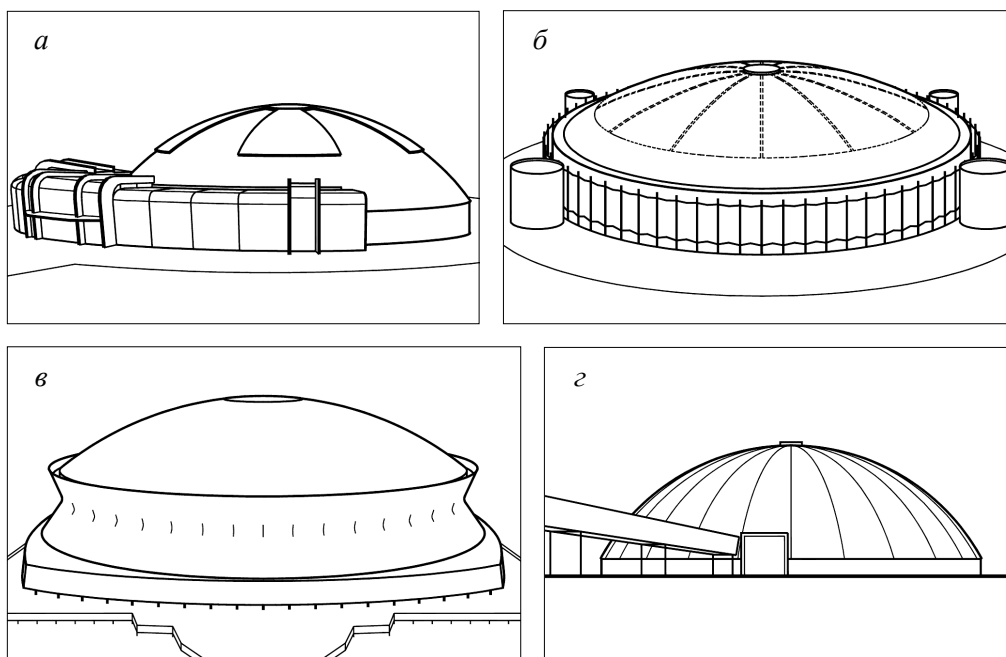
Здания с купольными покрытиями, при монтаже которых применялись несколько временных опор:
